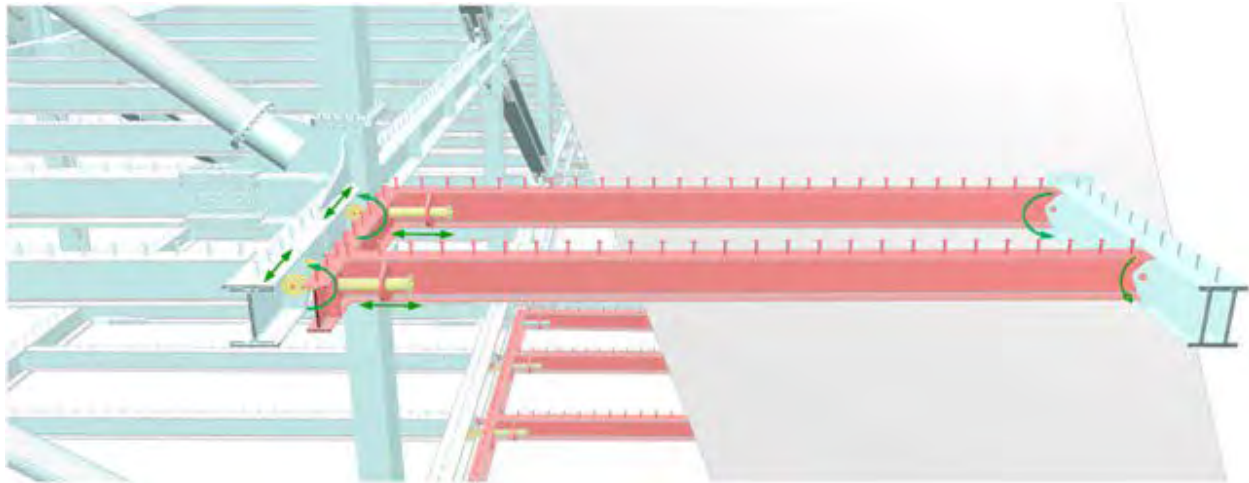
Forjados basculantes-deslizantes entre viga museo y forjados existentes.
